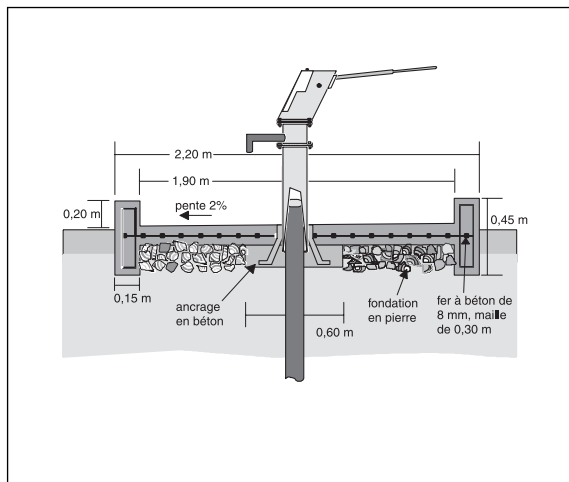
Coupe type de l'aménagement de surface d'un forage.
